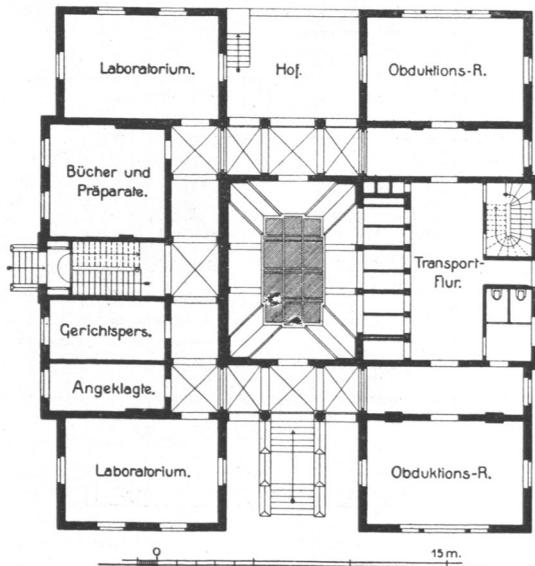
Hafenkrankenhause, Leichenschauhause und Anatomie, Erdgeschoß, Grundriß.
